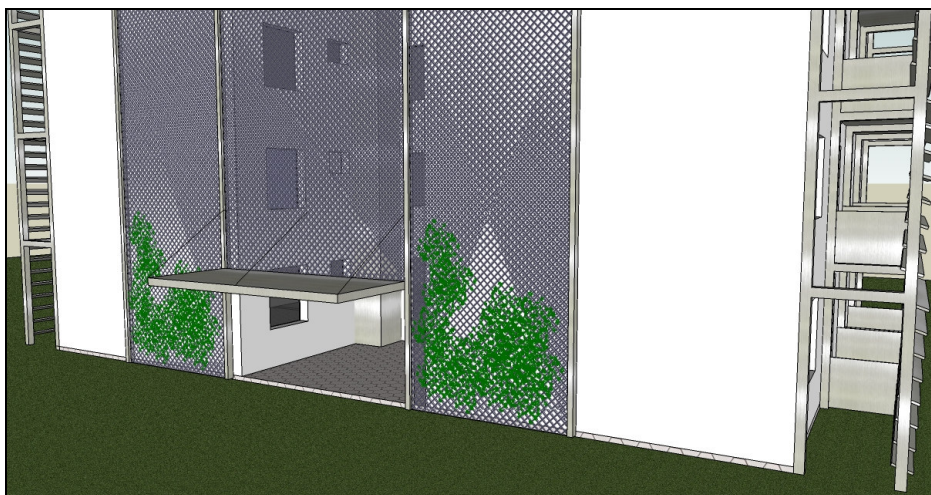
Detalhe da entrada do prédio – Opção B (estrutura e tela metálica como suporte para fachada verde)
